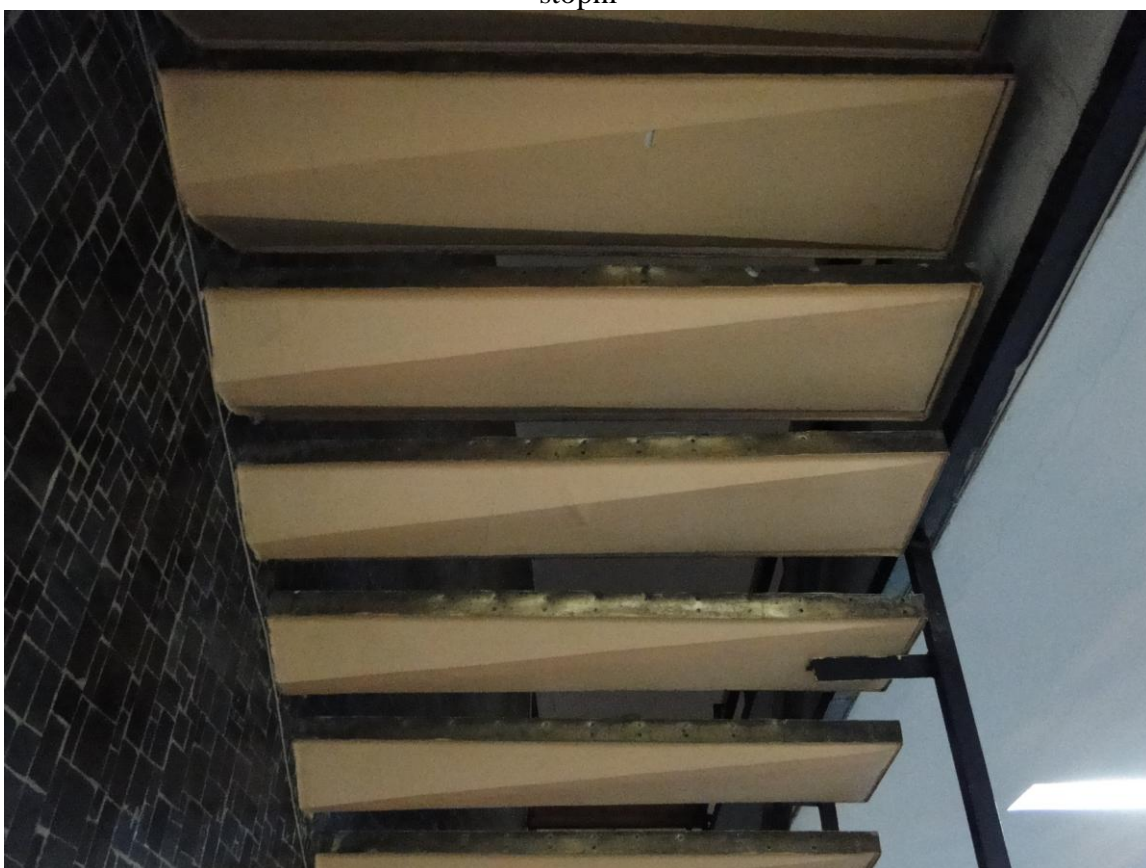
I piętro – zarysowanie stopni wspornikowych schodów
